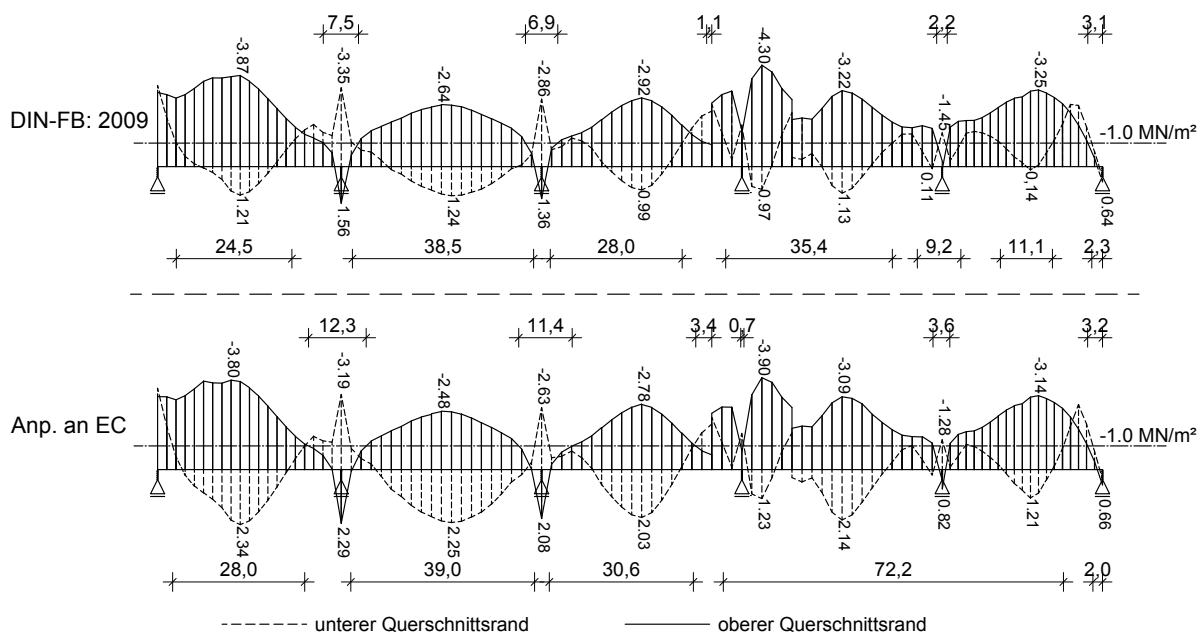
Mindestbewehrung zur Begrenzung der Rissbreite (Bauwerk 6)
